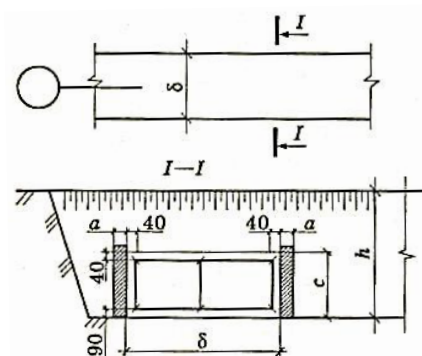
Общий вид монолитного фундамента с несъемной опалубкой
